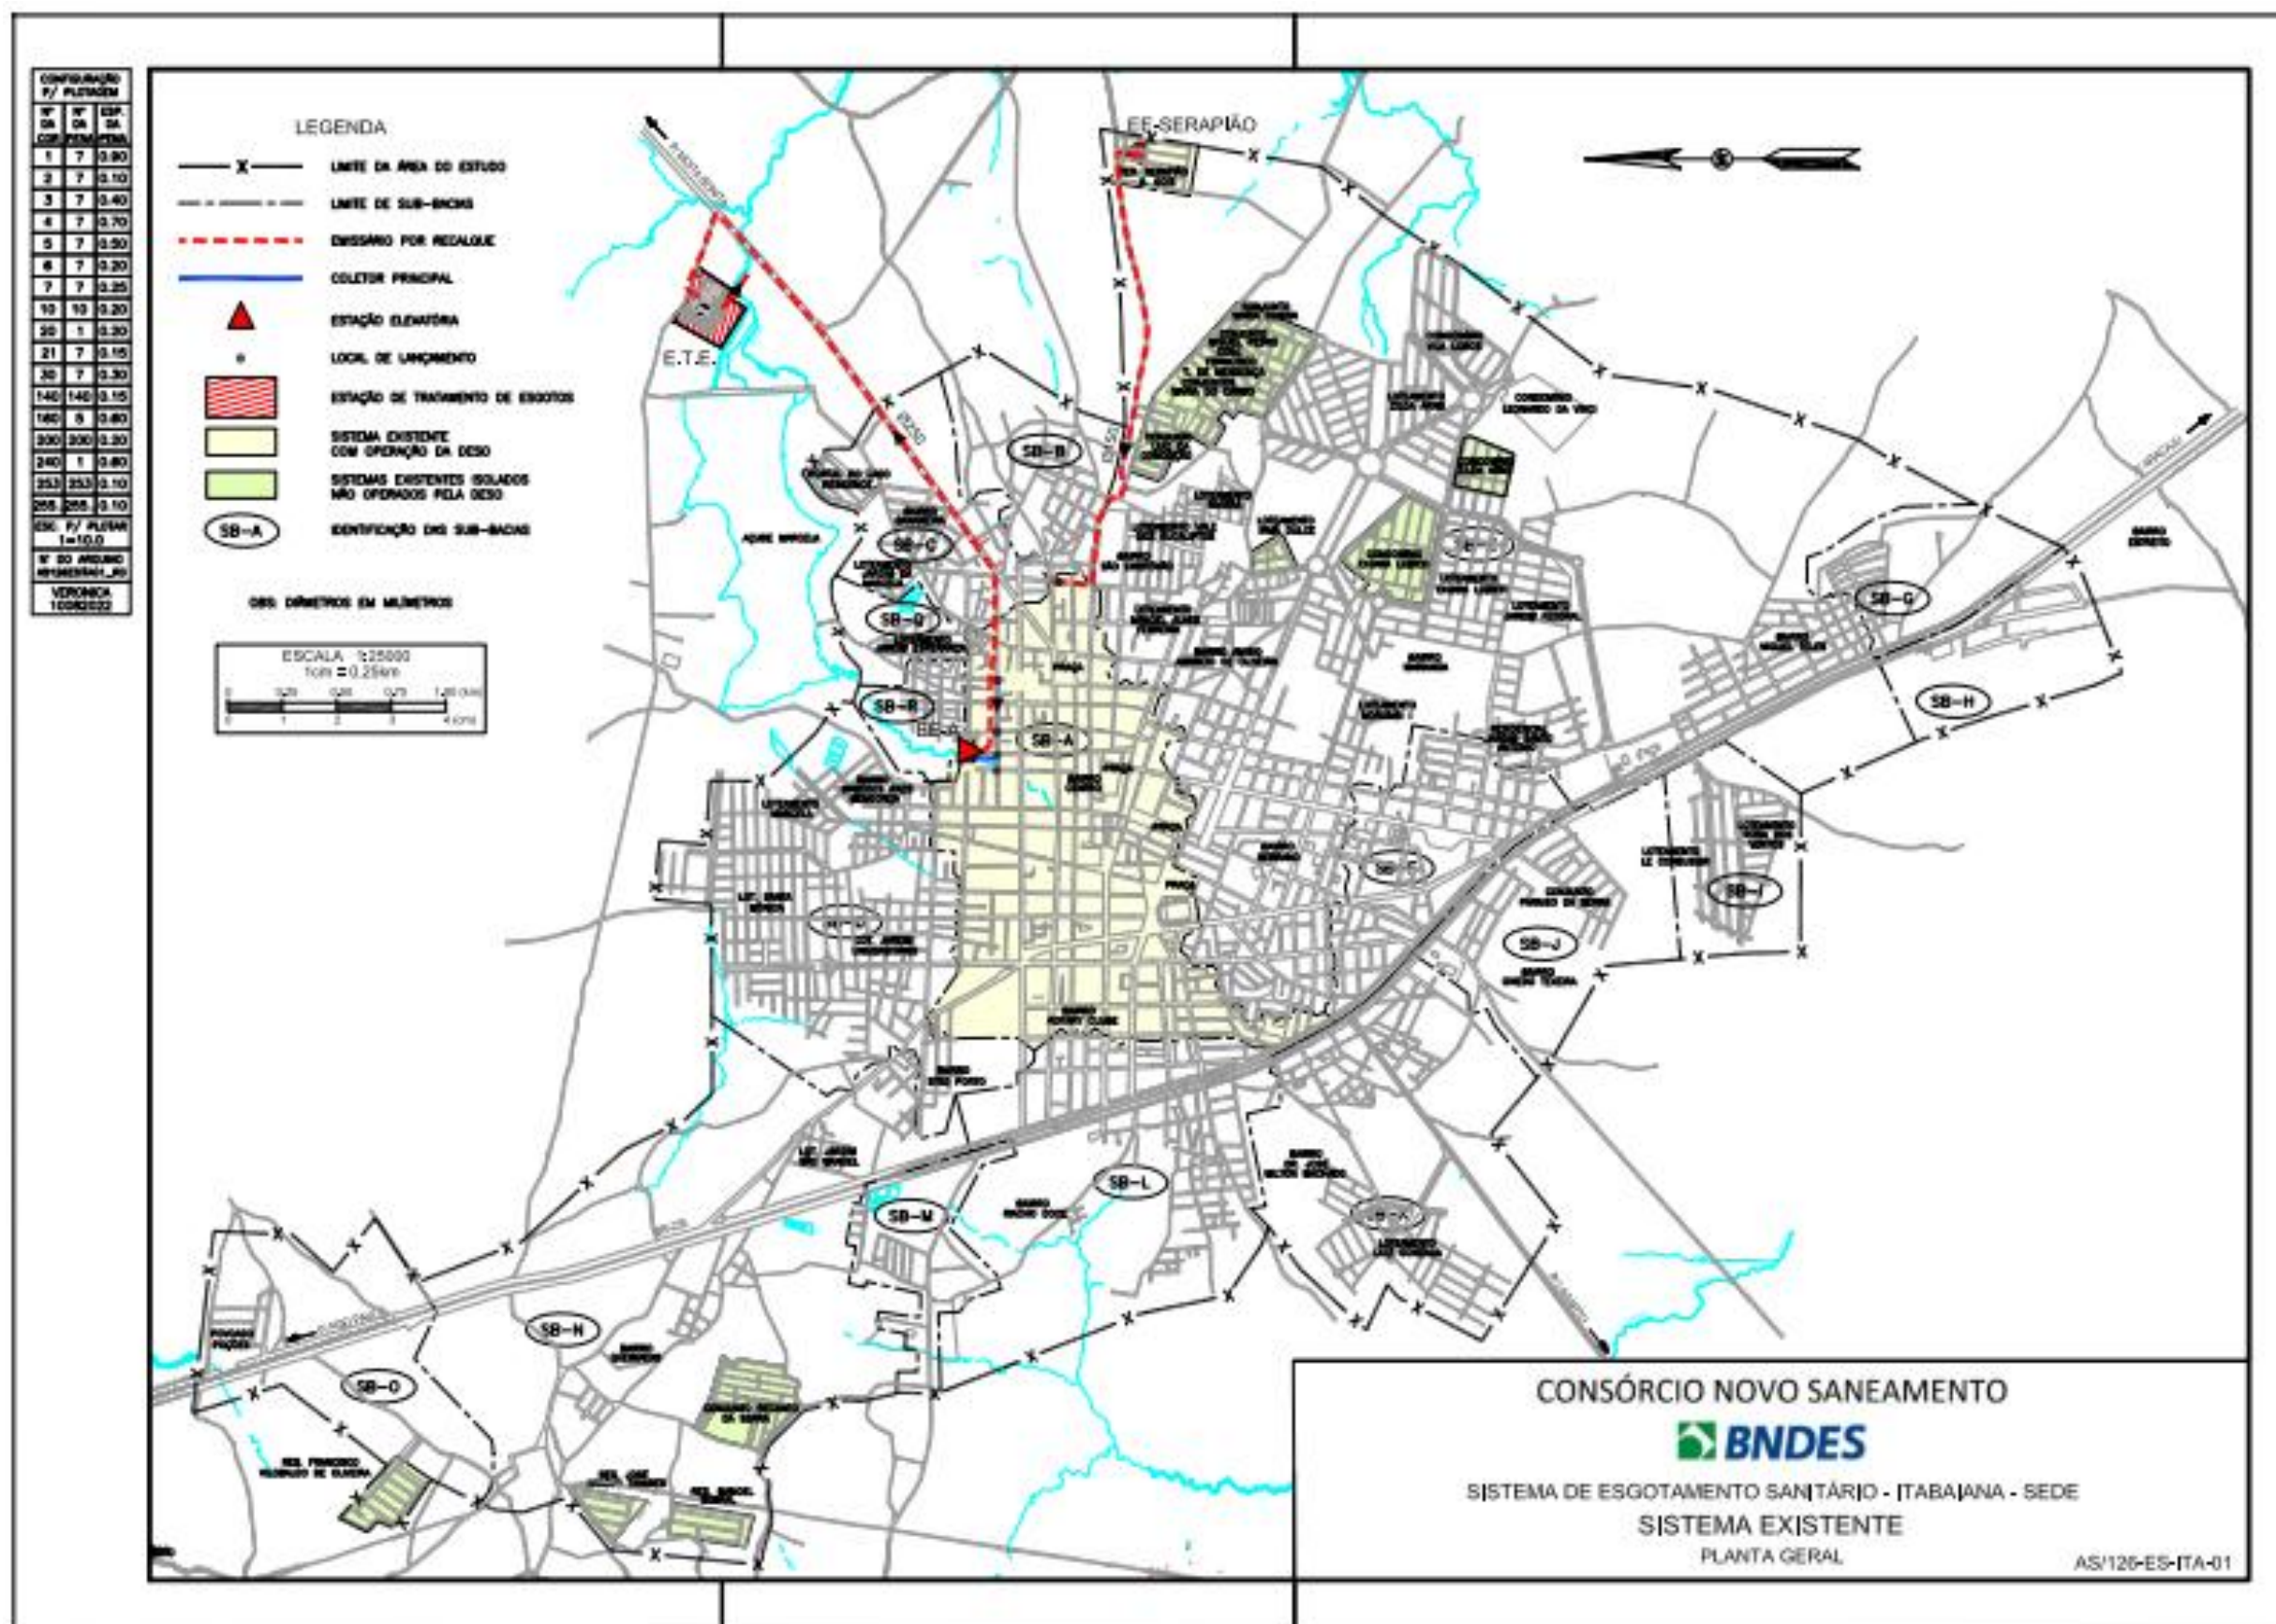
Planta do Sistema de Esgotamento Sanitário – ITABAIANA
